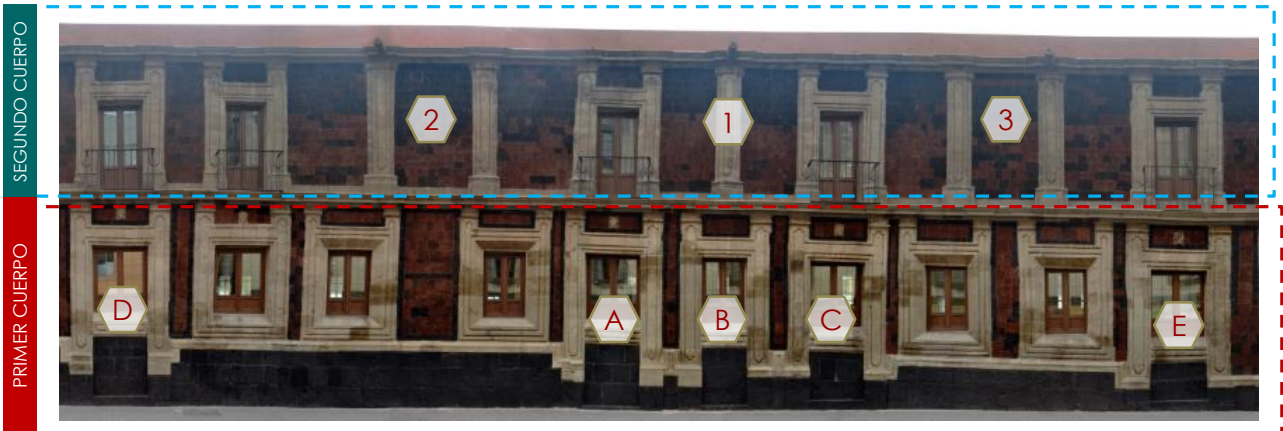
Sección de fachada correspondiente a un núcleo de las viviendas de alquiler que correspondiendo al conjunto de los Padres Camilos.
